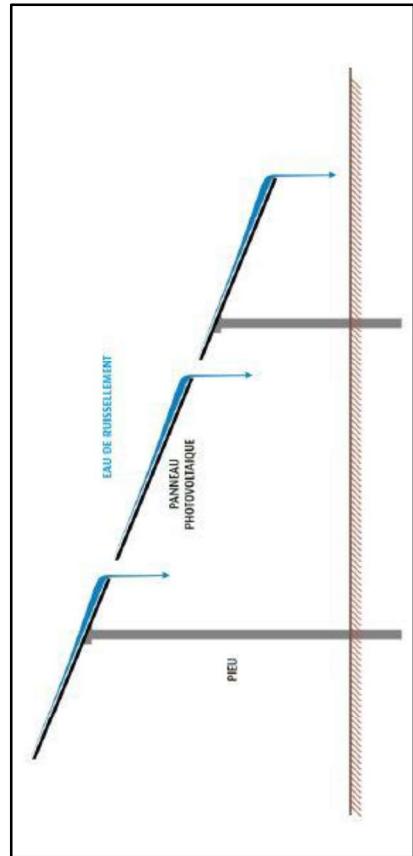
Schéma ruissellement des eaux pluviales sur les panneaux
